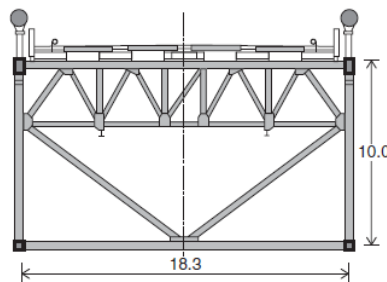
Tabuleiro com seção aberta em treliças metálicas.
